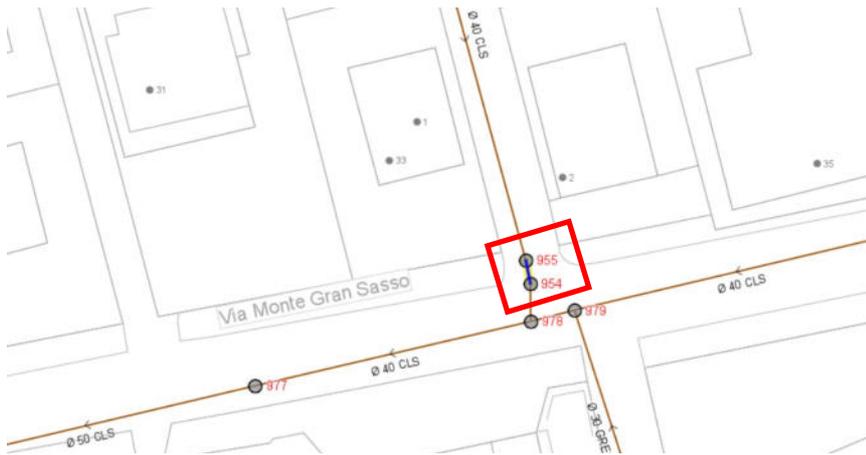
Tratto di rete oggetto di intervento strutturale IS05 (nel rettangolo rosso).
